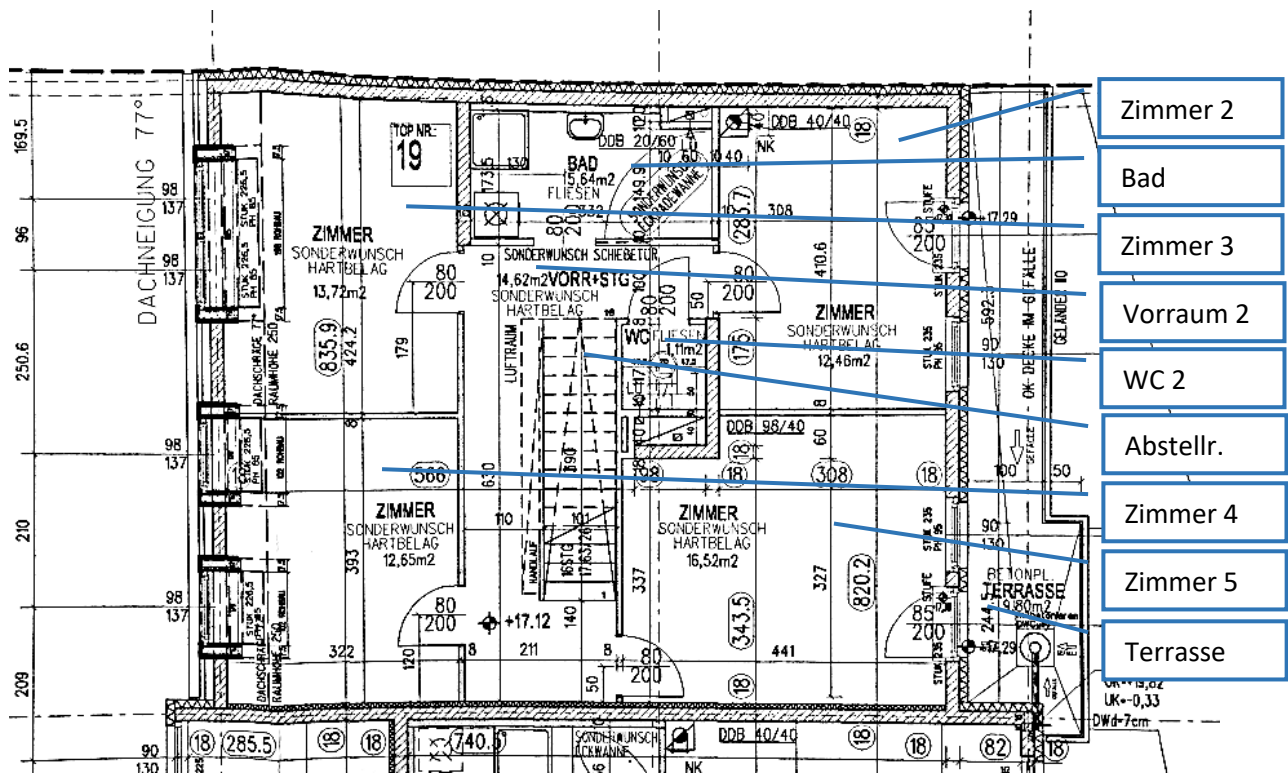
Auszug Bestandsplan (Fertigstellungsanzeige), 1.DG, Plan Nr.: 8
